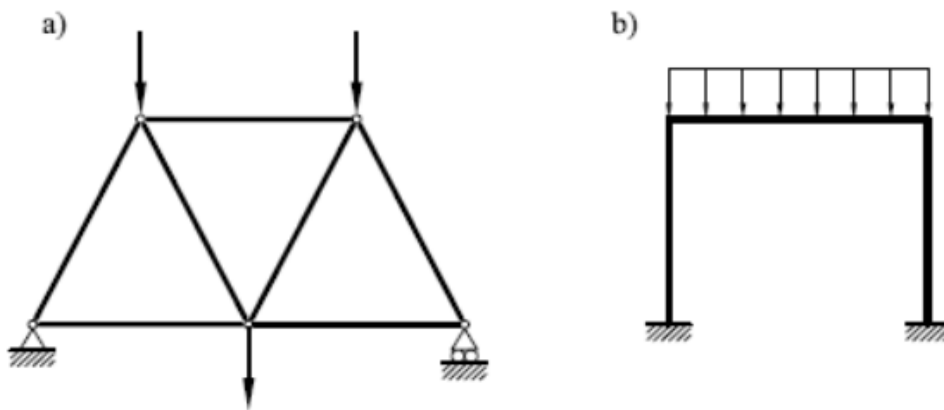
Tipos de estructuras a) articulada, b) reticulada
